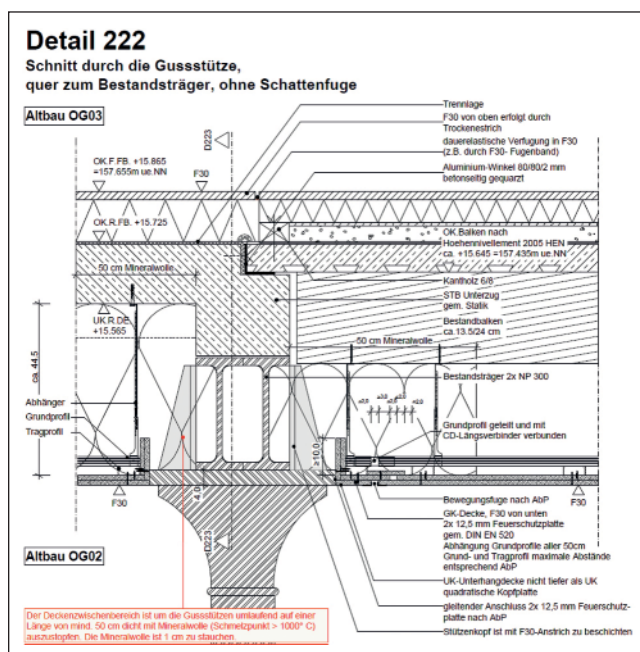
b: Detail eines Anschlusspunktes aus Holz, Stahl, Guss, geschützt durch Trockenbau und DSB
